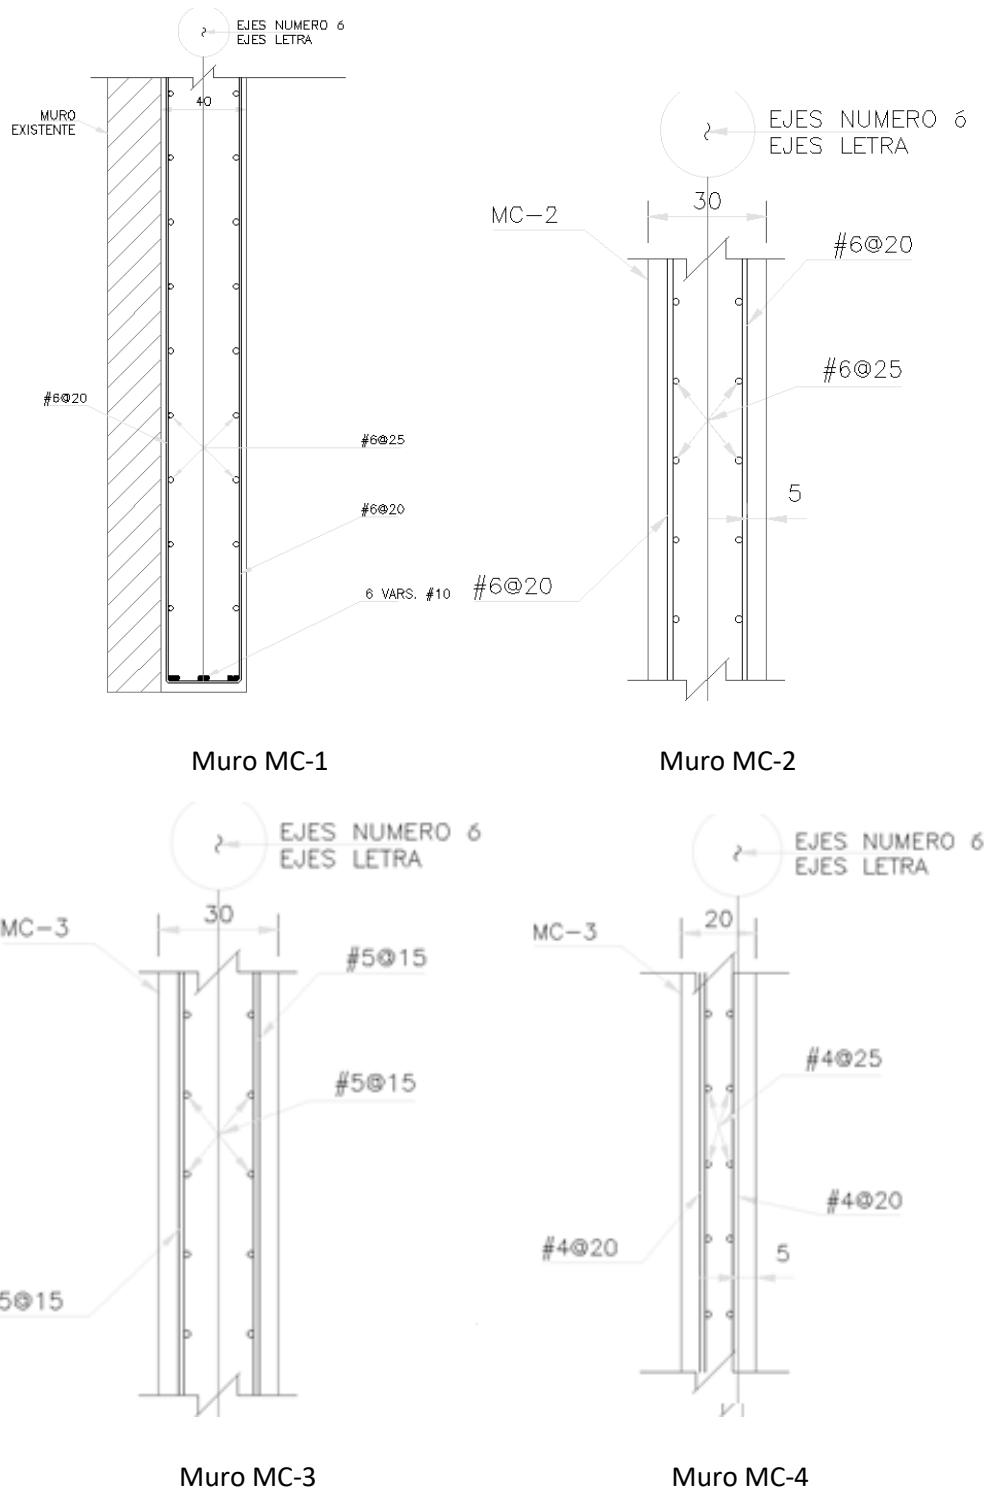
Armado de muros intermedios y laterales. Colinas de Buen S.A de C.V. (2016)
